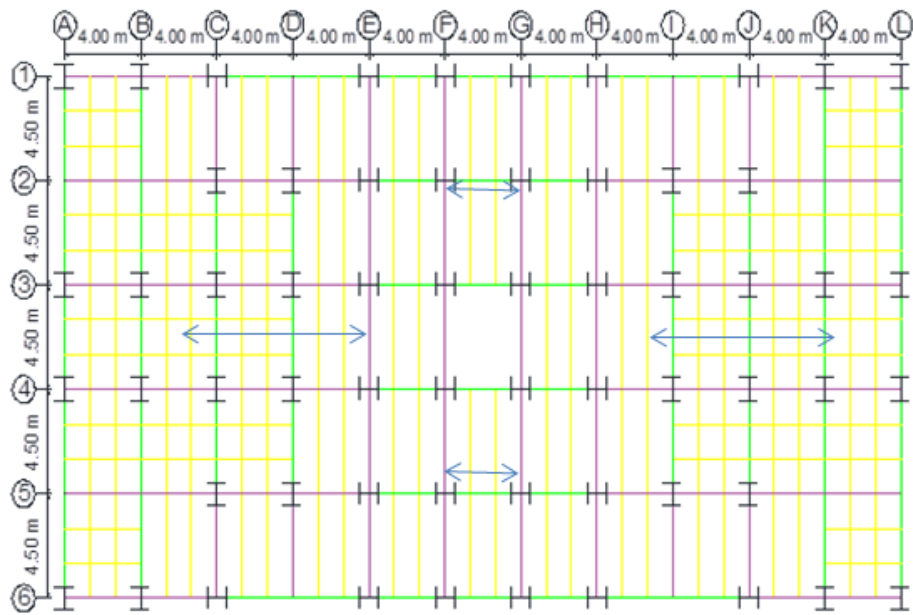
Planta de entrespiso de la edificación con panel Vierendeel de 2m.
